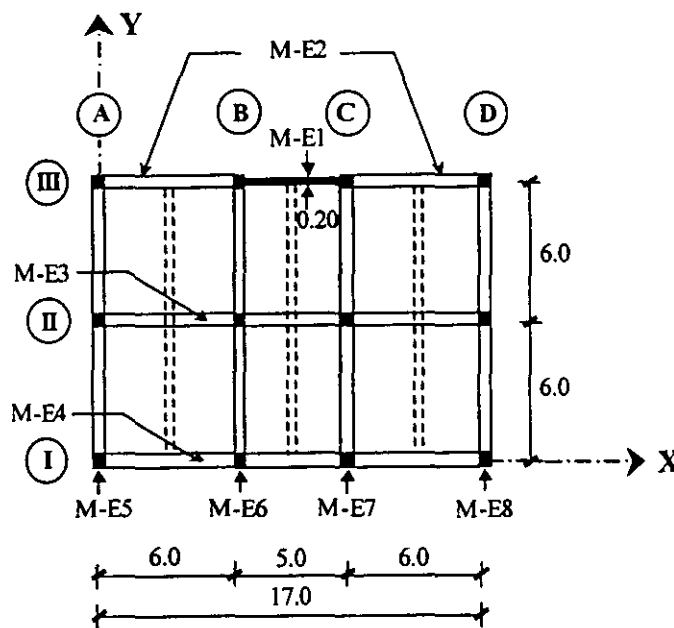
Planta del edificio de siete niveles, (Kilar y Fajfar, 1997).
